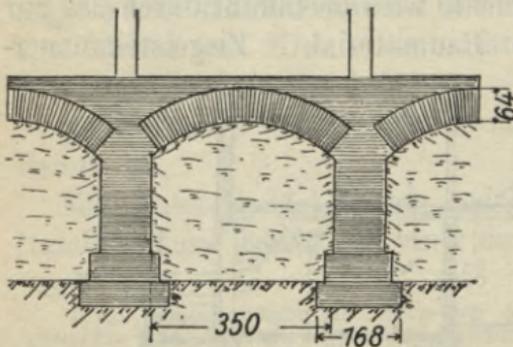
Grundpfeiler mit Erdbögen in Ziegelmauerwerk.
